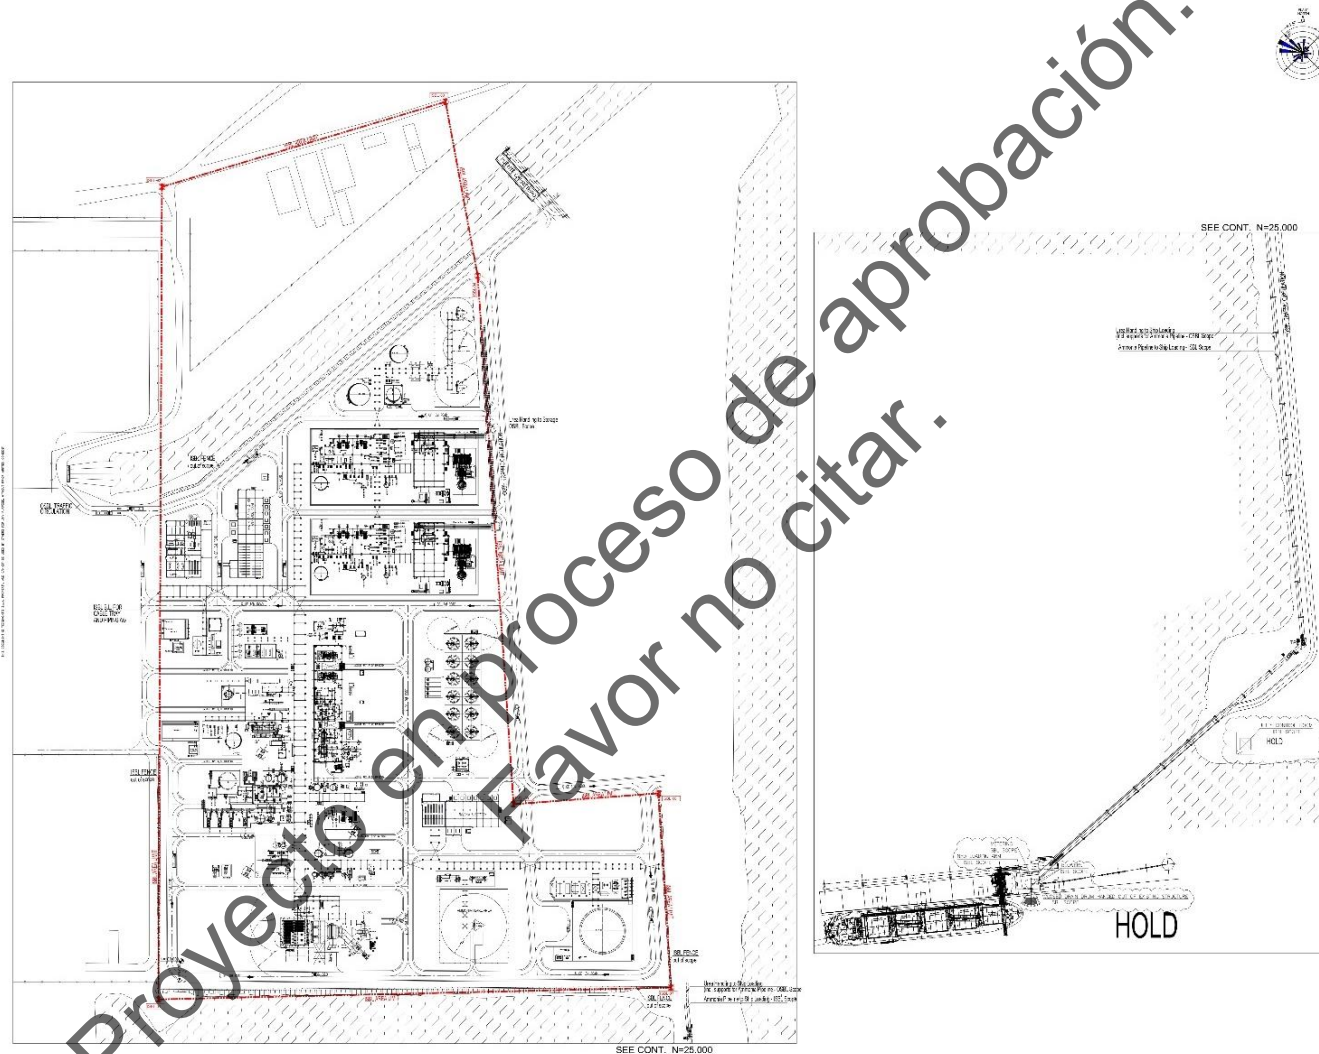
Layout ISBL de Planta de Fertilizantes. Imagen izquierda: vista de la planta productiva. Imagen derecha: vista del viaducto de conexión al muelle.
